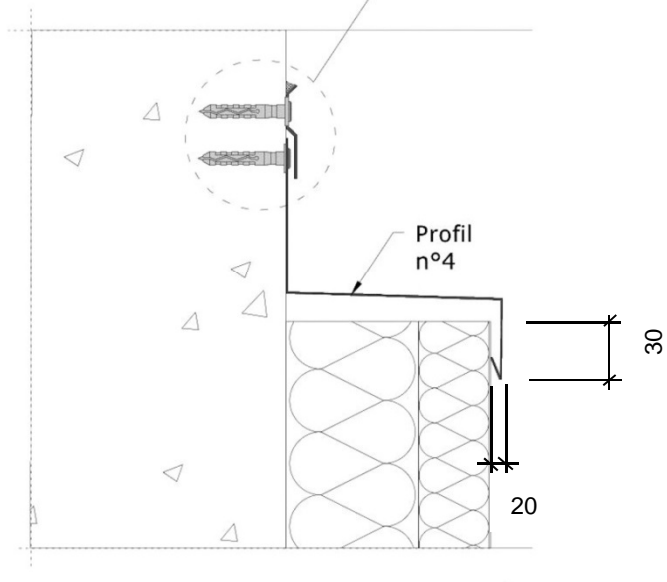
Haut de façade – Pose en vêtage (coupe verticale)
